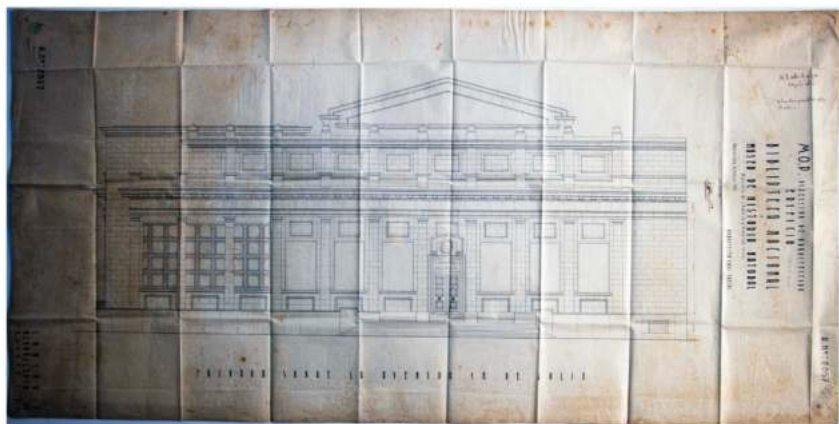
Fachada del proyecto ejecutivo. BN. Archivo Administrativo.
